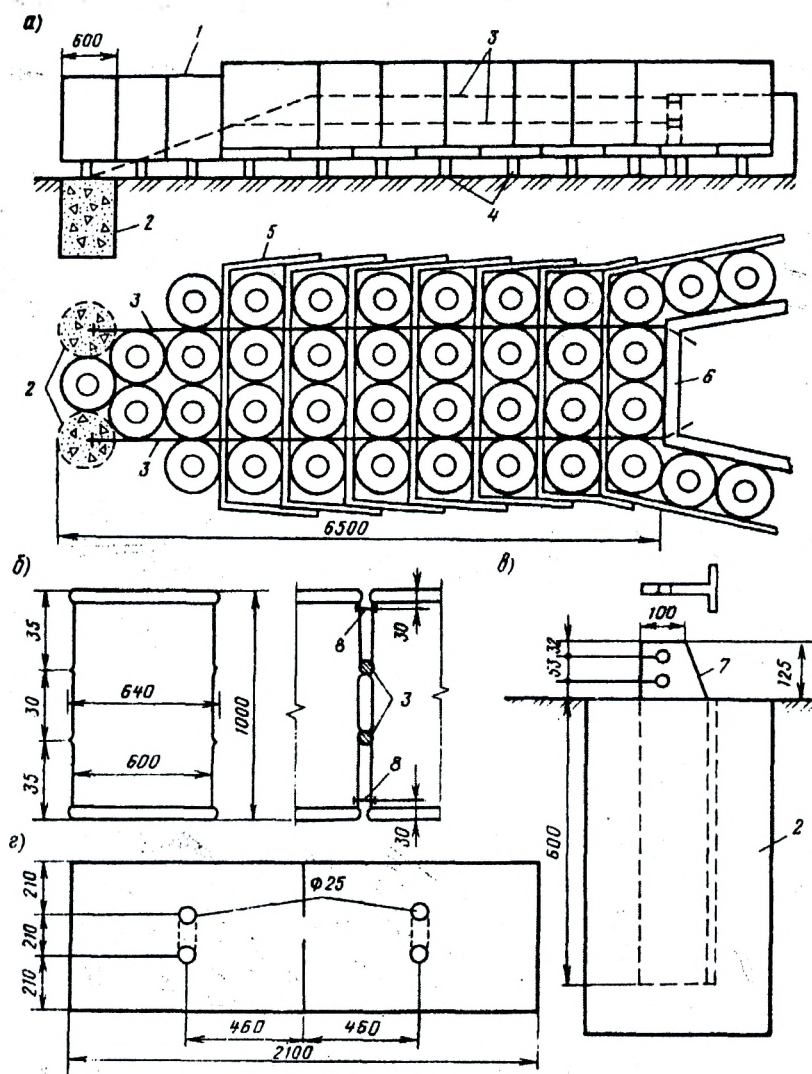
Останавливающее ограждение из стальных бочек: а – фасад и план; б – соединение бочек; в – железобетонный анкерный блок; г – перегородка между секциями; 1 – бочка с отверстиями в крышке и днище; 2 – цементобетон; 3 – стальной трос  $d=20$  мм; 4 – пара скоб, приваренных к днищу бочки; 5 – боковая панель; 6 – массивная железобетонная стенка перед препятствием; 7 – стальной тавр; 8 – болтовое соединение
